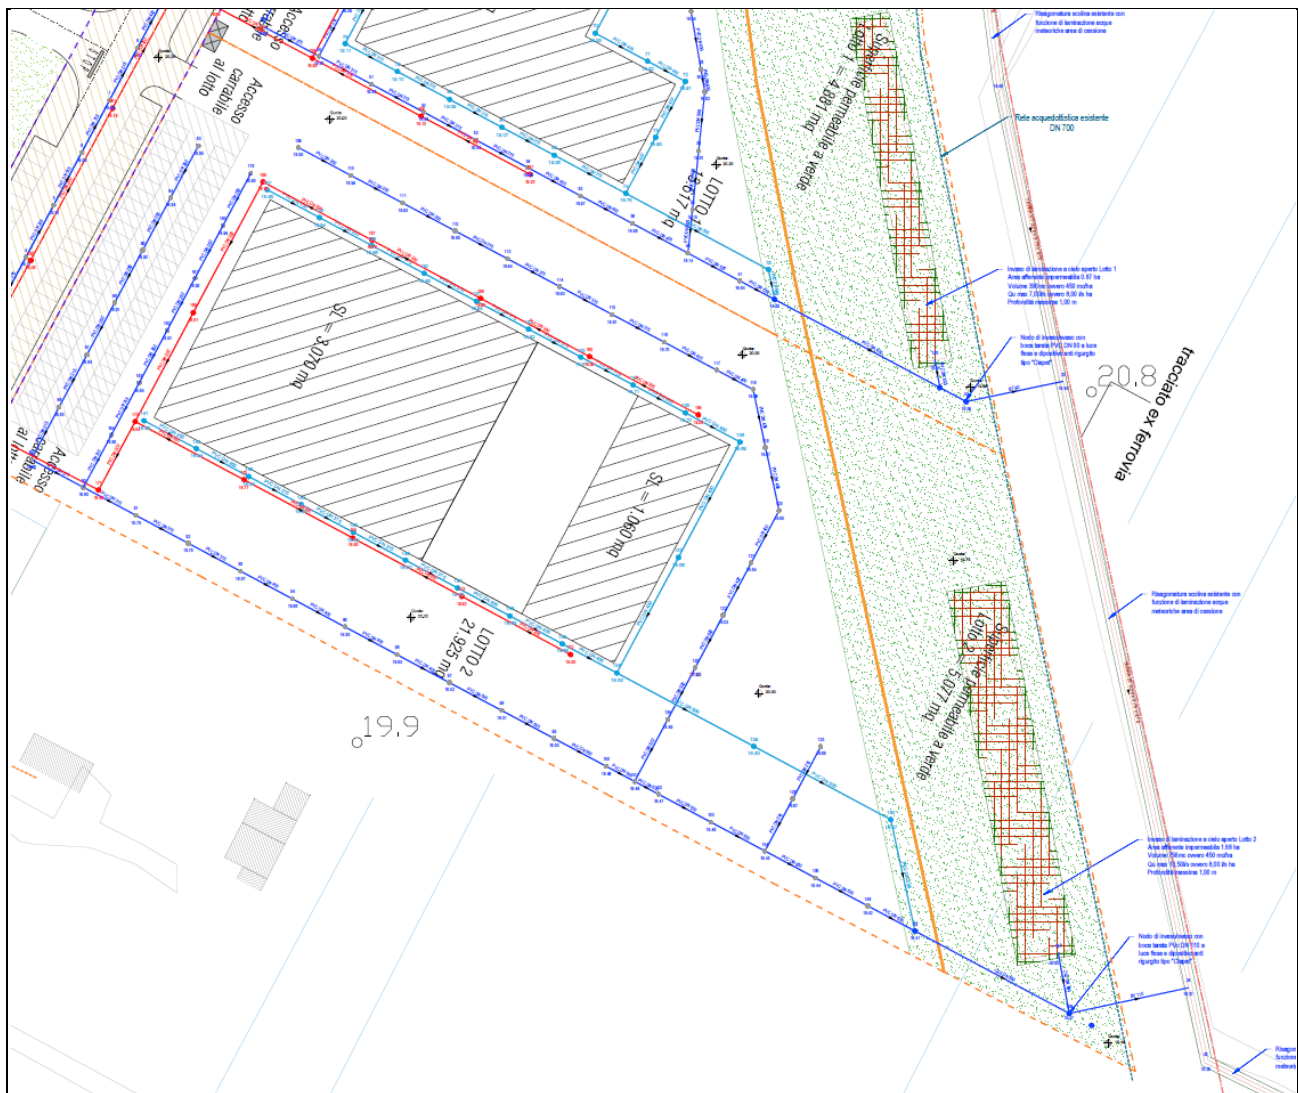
Inquadramento planimetrico volume di laminazione Lotto 2
